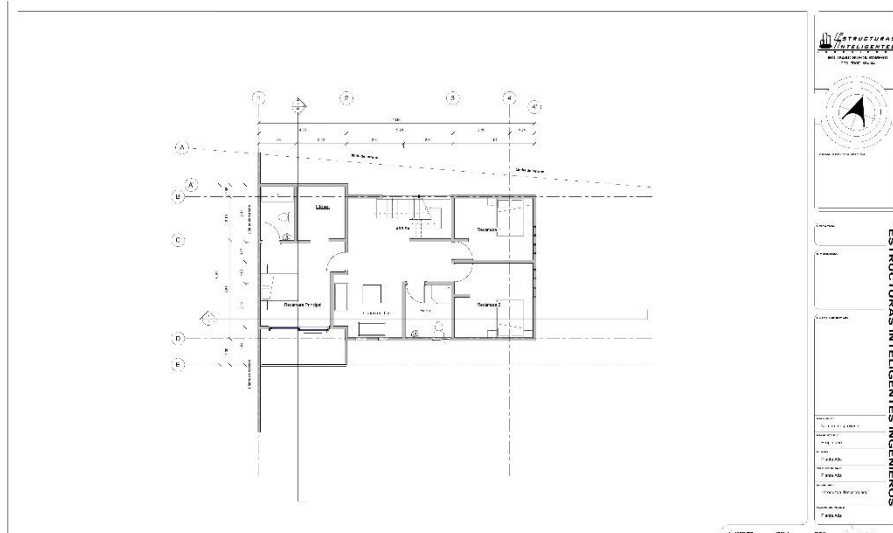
Planta alta de la propuesta arquitectónica en Tepetlapa, Xochimilco.
